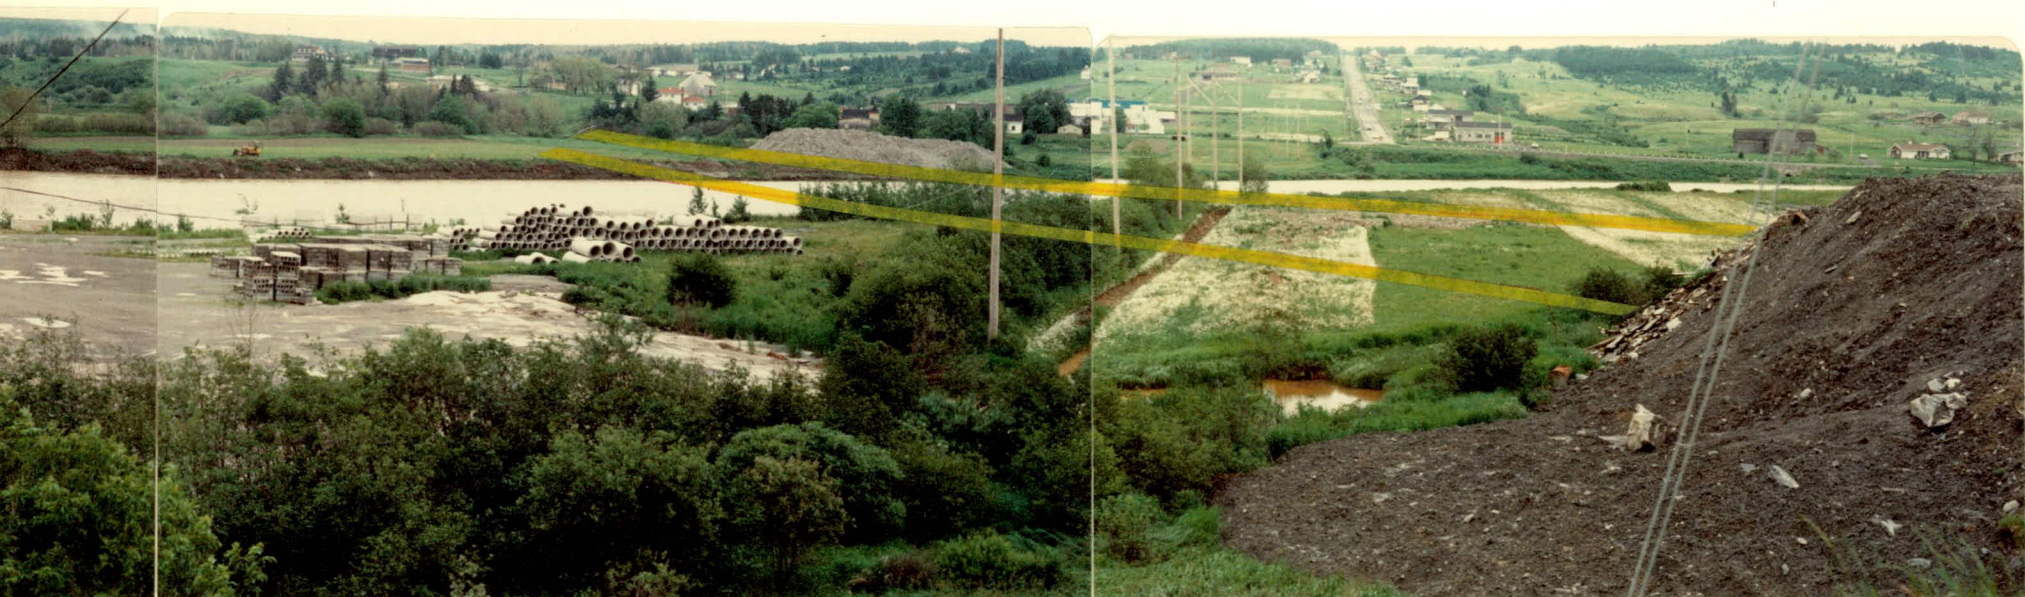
Traversée de la rivière Chaudière. Cette partie de la plaine de débordement sera également perturbée par les travaux de raccordement de l'autoroute à la route 173, et par la construction du pont reliant l'autoroute à Saint-Georges ouest.
